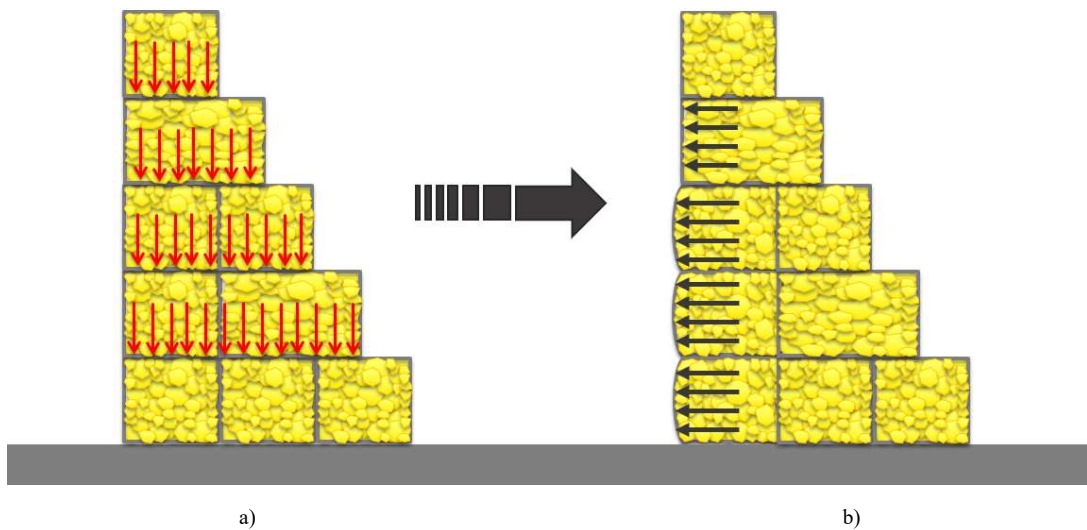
Tensões atuantes sobre as camadas de um muro de gabião: a) tensão vertical por camada; b) tensão horizontal aplicada sobre a face externa do muro por camada.
